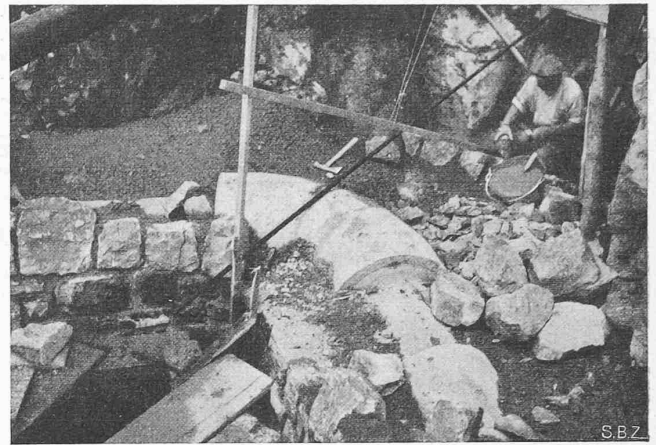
Winkelpunkt der Hangleitung aus Schleuderbetonrohren
